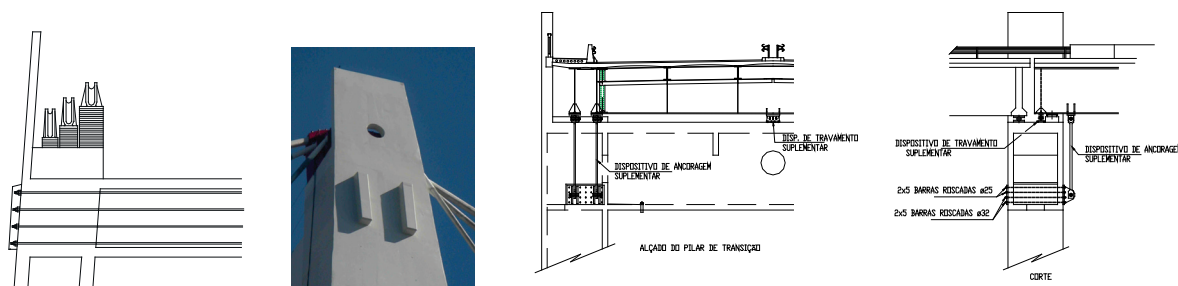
Reforço da travessa dos mastros e da fixação do tabuleiro no pilar de transição
